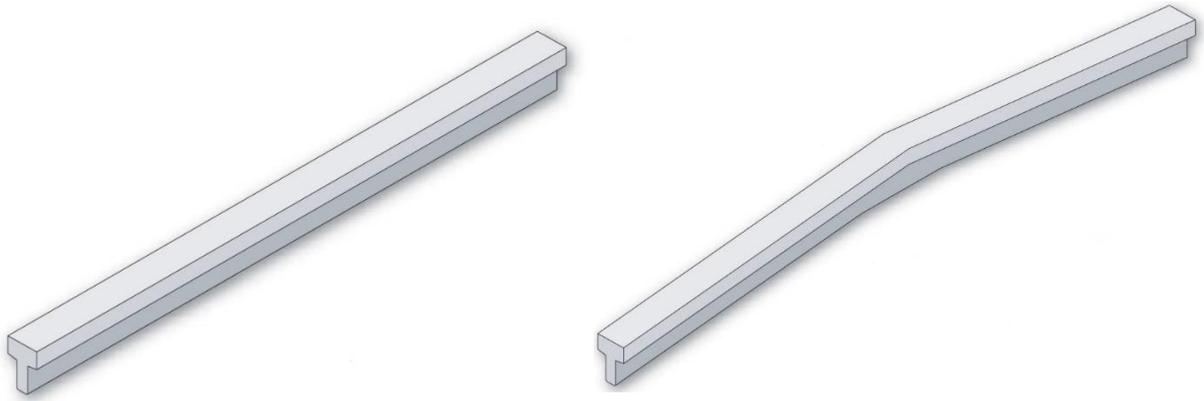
Vigas tipo Piñón y Boomerang. [13]
